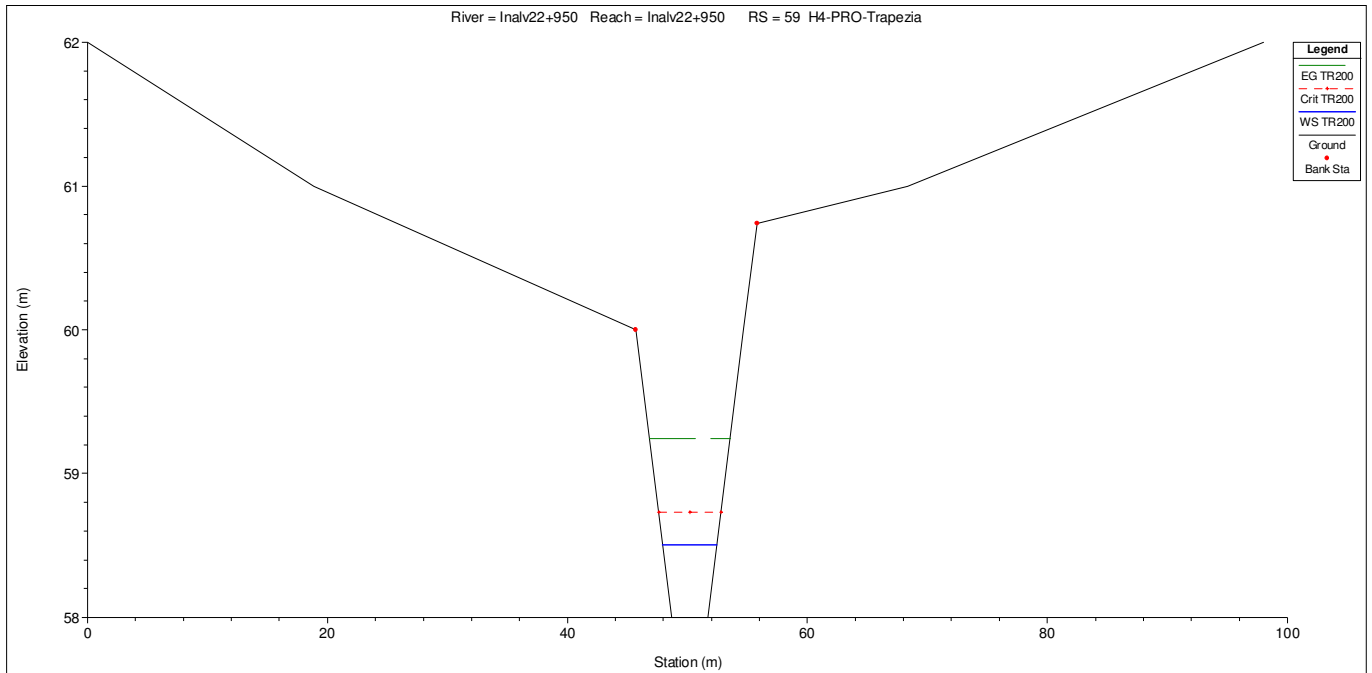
Inalveazione pk.22+950 – Scenario Progetto – HEC-RAS – Sezione canale cls trapezia
